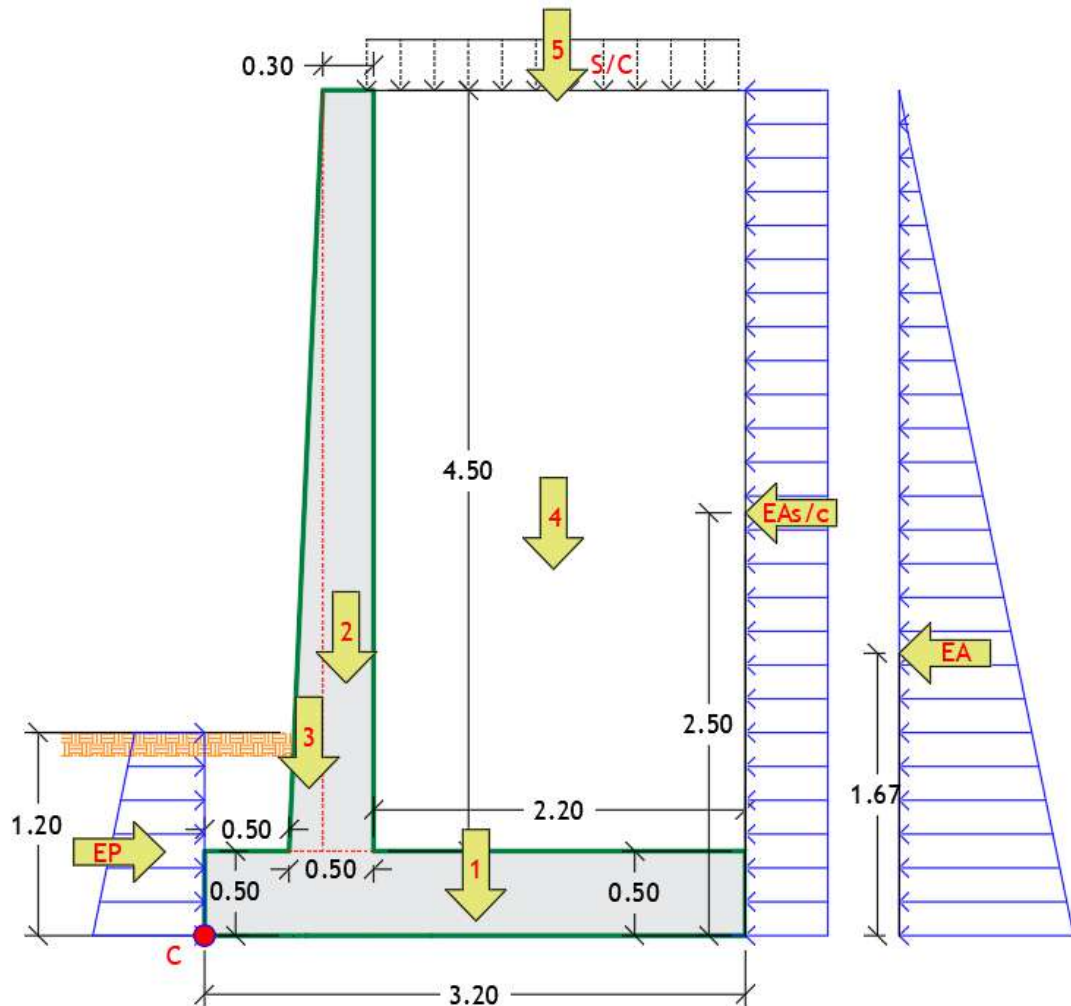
Partes de un Muro en VoladizoNota.* Fuente: (Torres Belandria)
